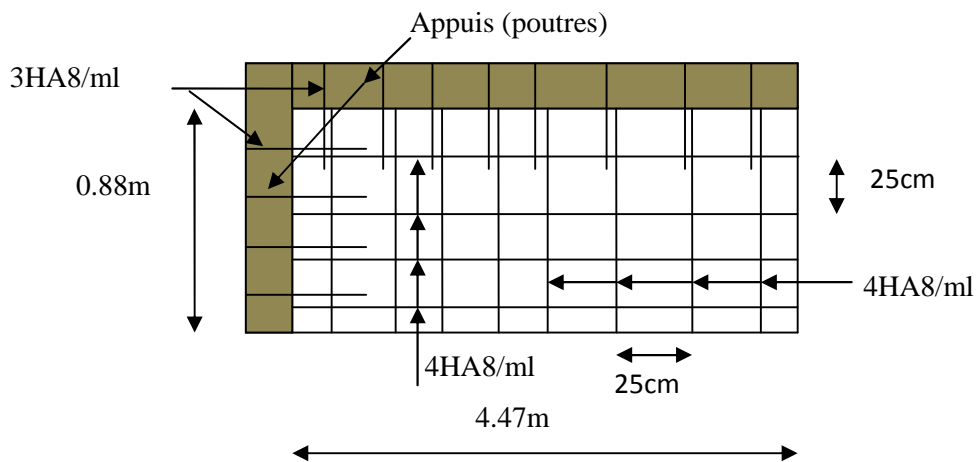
Schéma de ferrailage des dalles sur 2 appuis.
